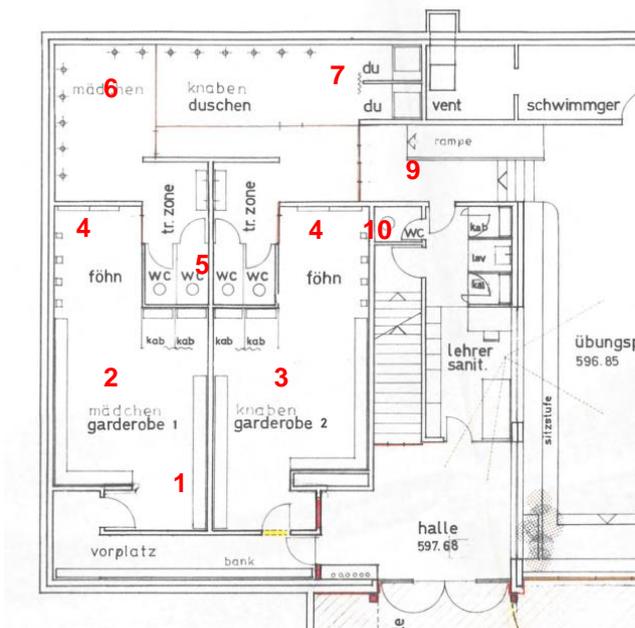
Grundriss Garderoben (ohne Massstab)
